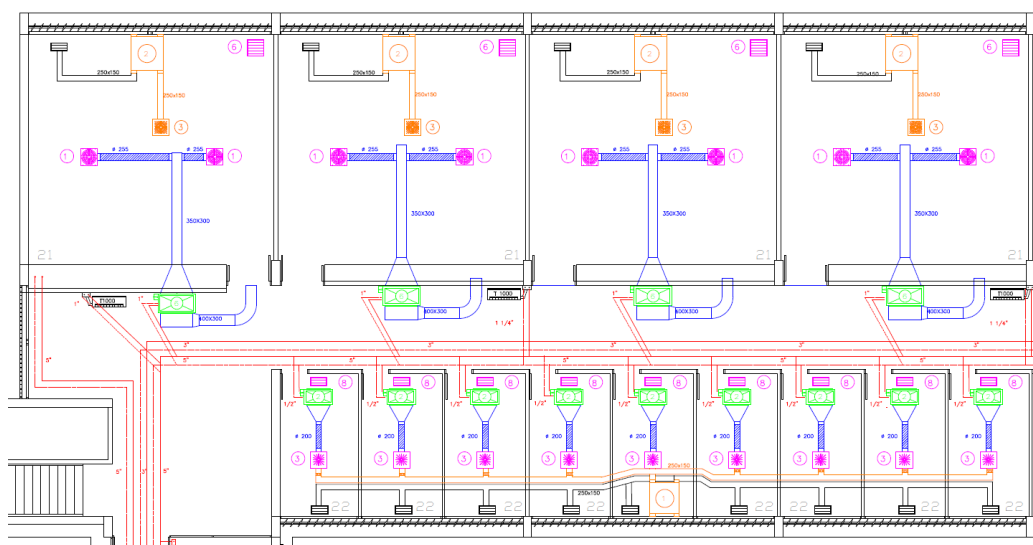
Vista de los equipos de ventilación descentralizados del DIM en la planta baja. Fuente: Elab. propia.
